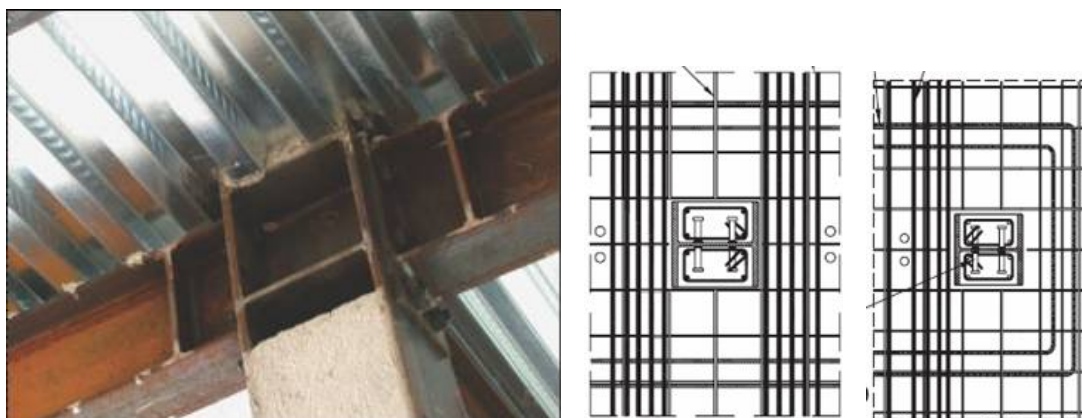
Detalhe da ligação e das armaduras transversais utilizadas por Braconi *et al.* (2007).
